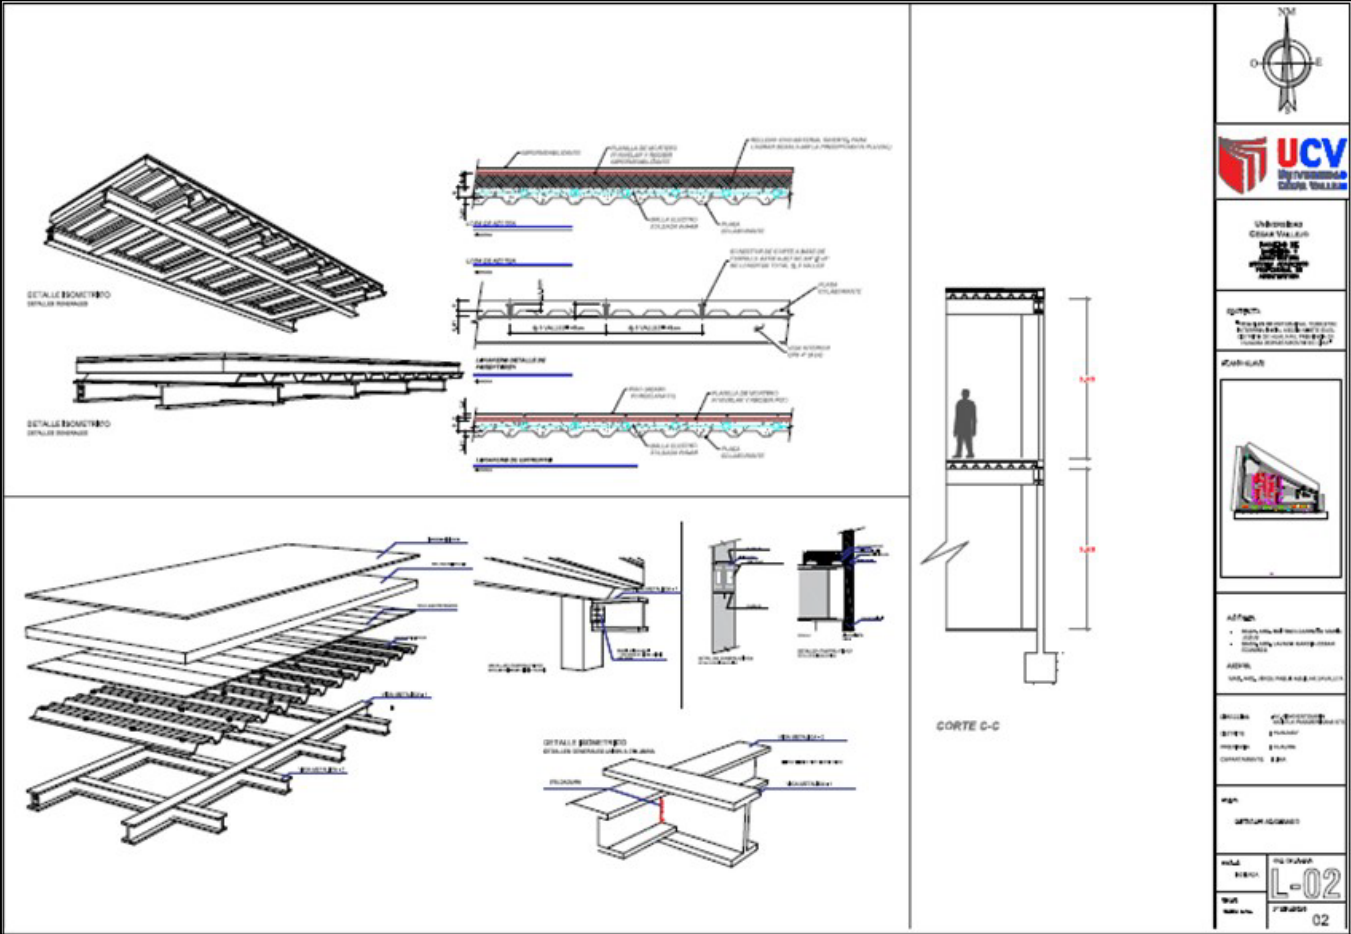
Plano de detalle de losa aligerada - elaboración propia
